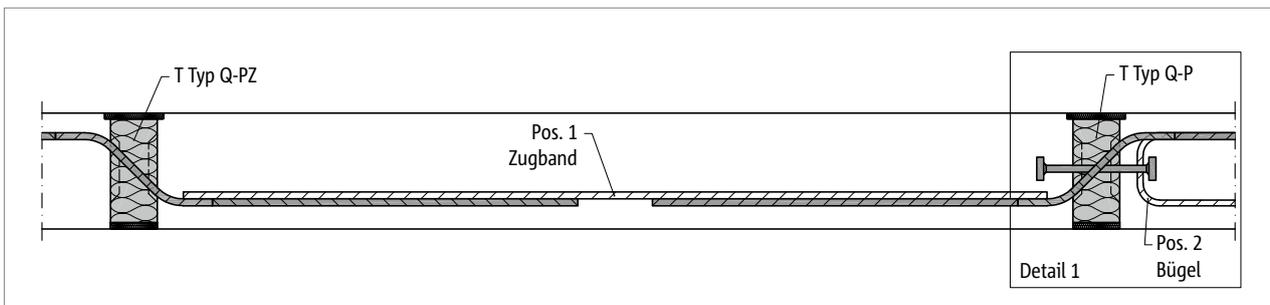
Schöck Isokorb® T Typ Q-PZ, Q-P: Schnitt A-A; Bewehrungsanschluss Zugband
